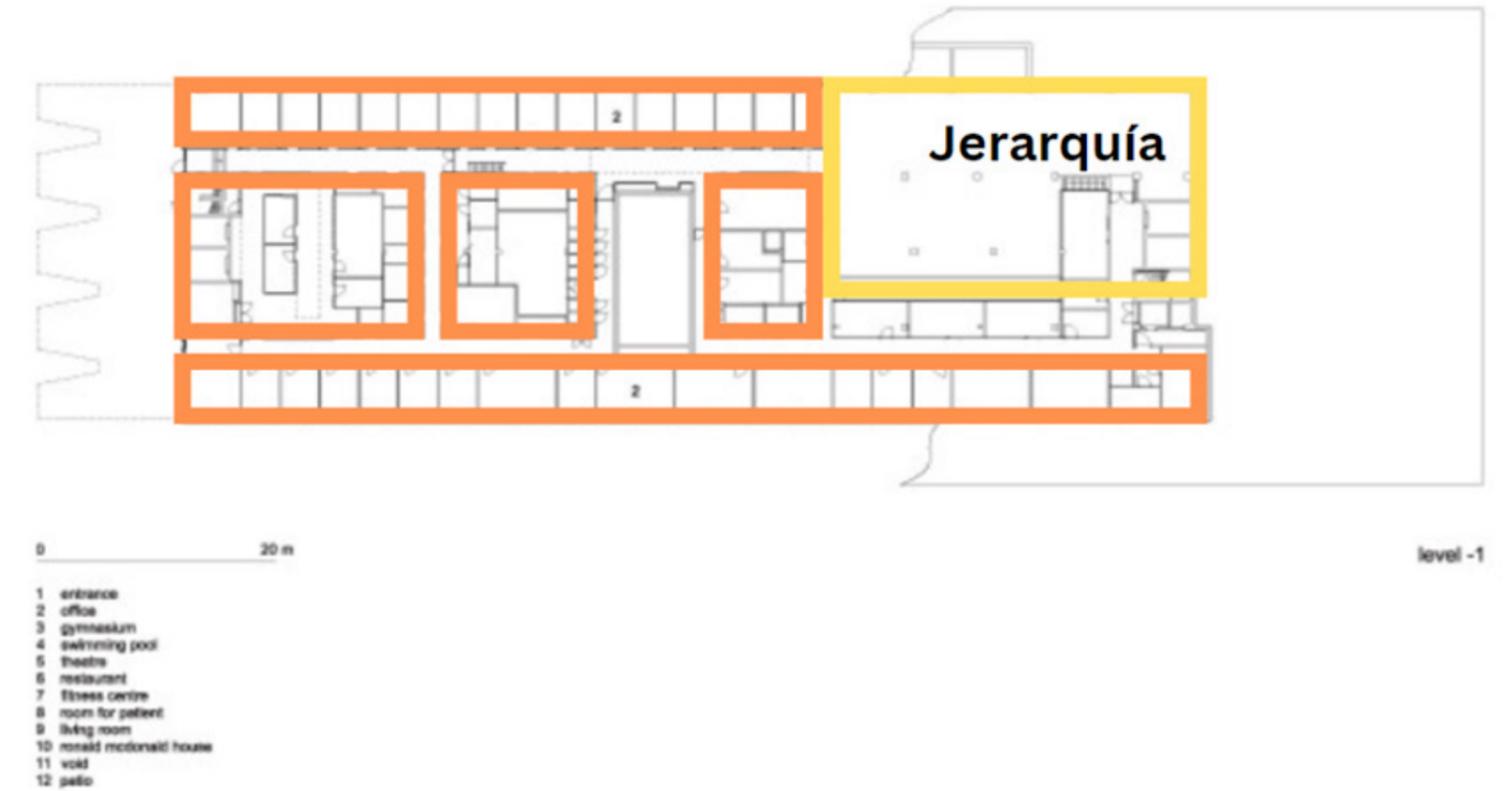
Planta arquitectónica del Centro de Rehabilitación de Países Bajos
